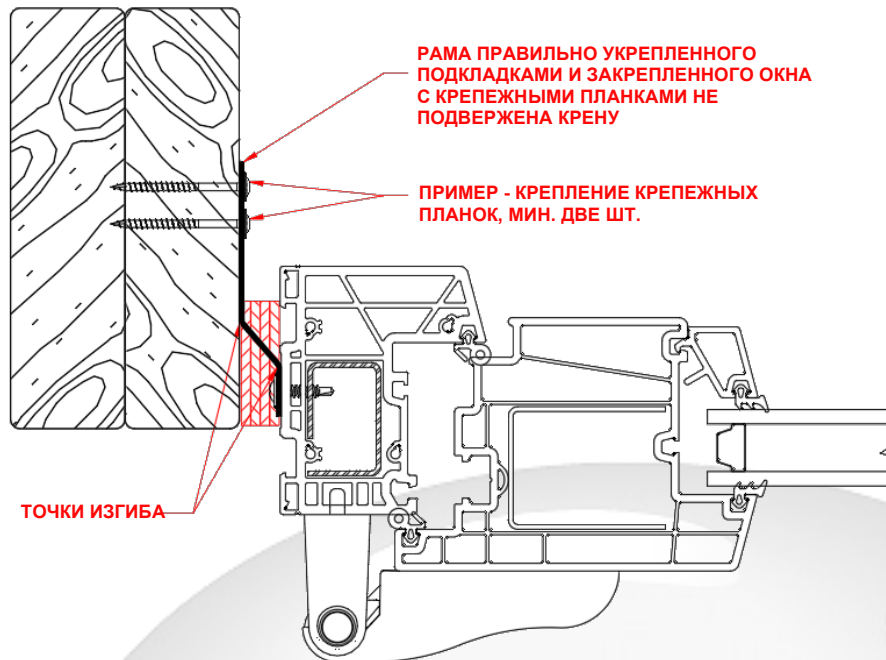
Пример правильно укрепленной подкладками и закрепленной двери со стальной планкой
